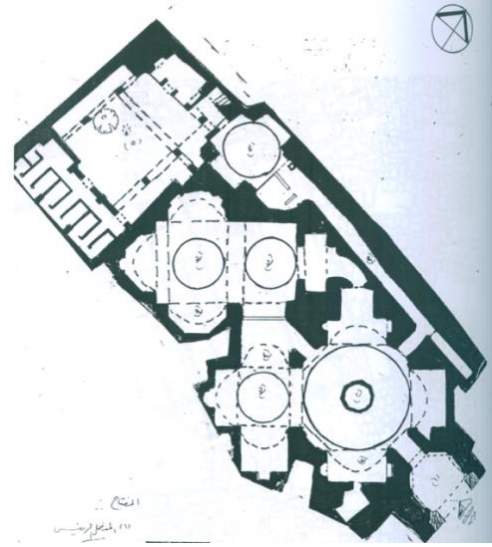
مسقط أفقي لكنيس ملا ديفيد
